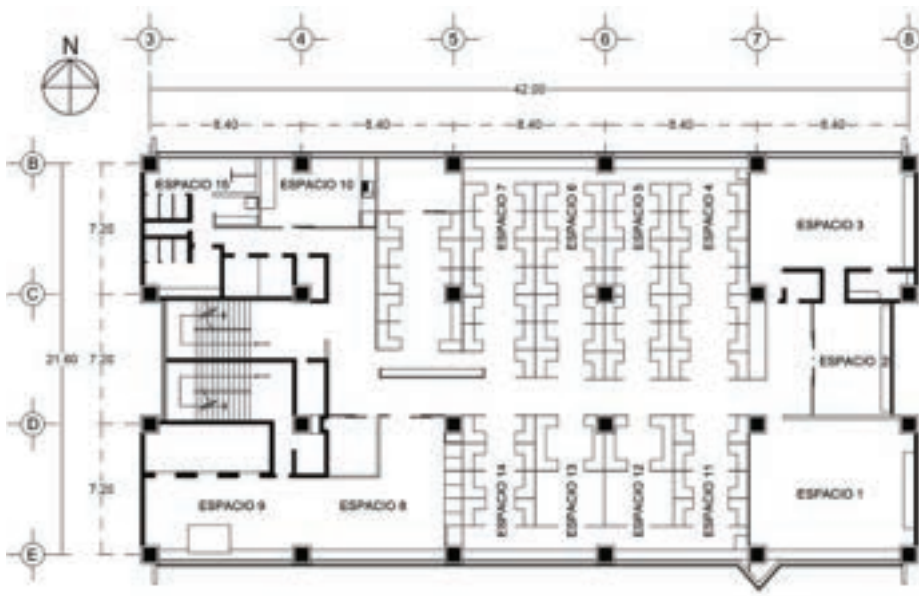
Planta arquitectónica del Edificio Cultural y Administrativo. Fuente: elaboración propia con base en los archivos oficiales.
